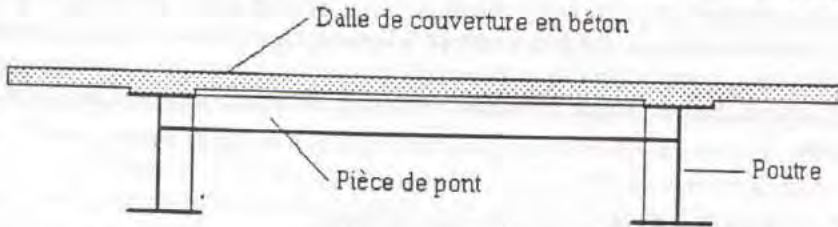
Coupe schématique d'un pont mixte bipoutre à pièces de pont.
